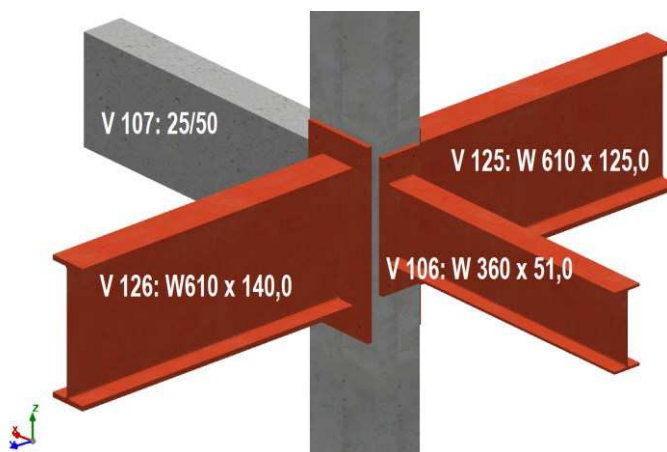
Modelagem do edifício de 10 pavimentos (estrutura associada)
